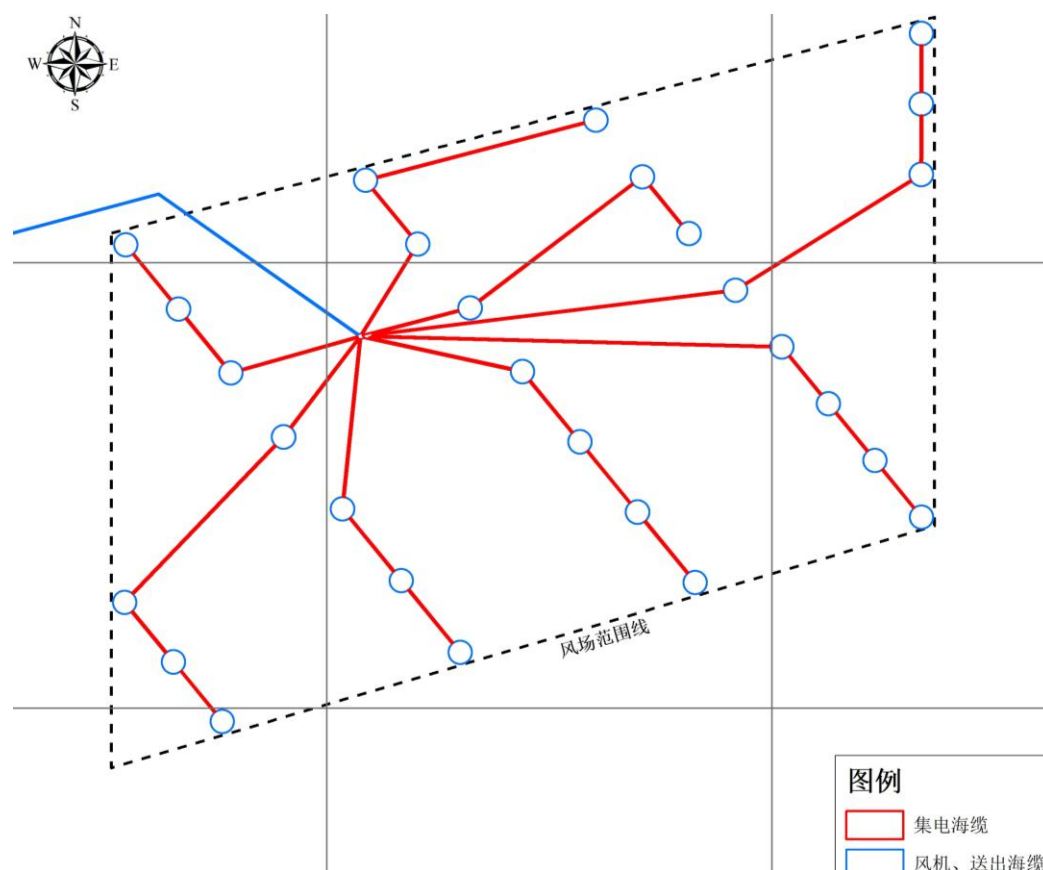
项目 66kV 集电海缆平面布置示意图
